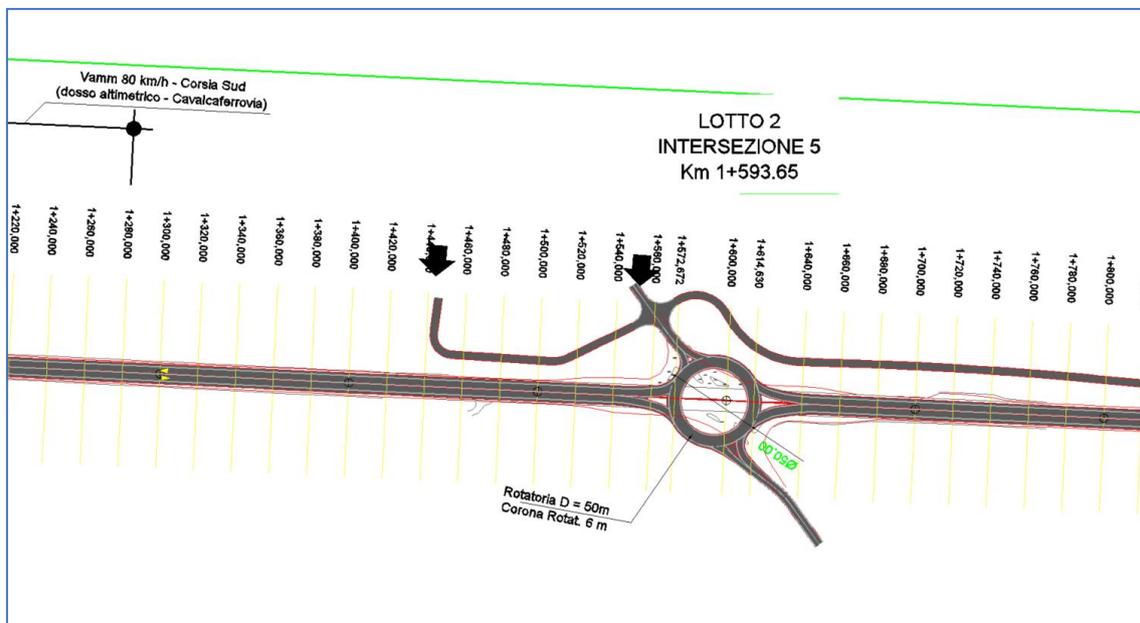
Intersezione 5 - Km 1+593 – Progetto
